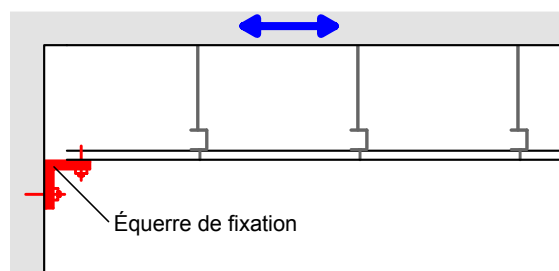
> Ancrage horizontal contre la paroi
